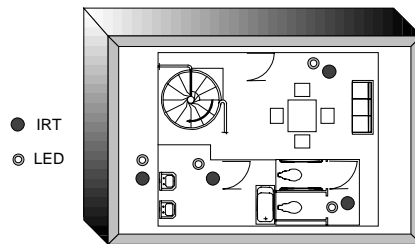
Anzeige- und Bedientableau. Bestückungsbeispiel mit Lageplan
